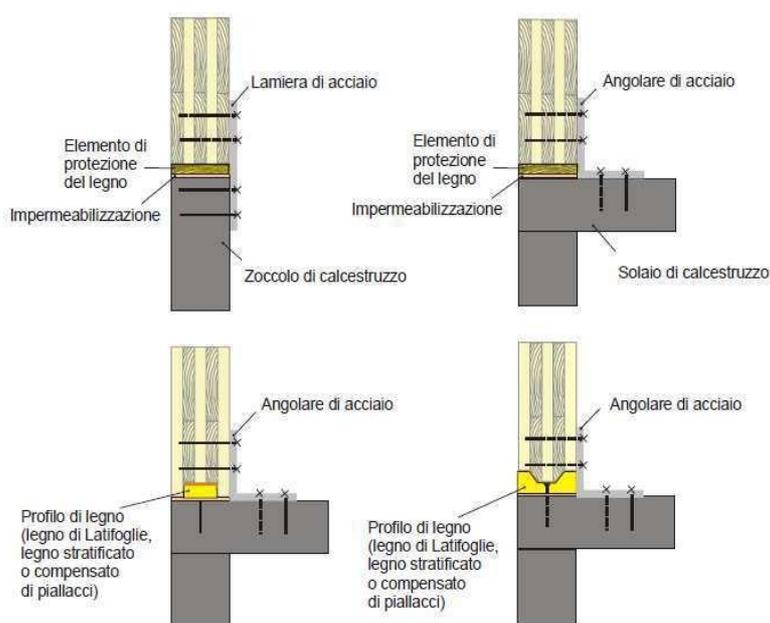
Giunzione parete fondazione, disposizione di lamiere e angolari d'acciaio come rinforzo ed ancoraggio per gli sforzi di trazione.
